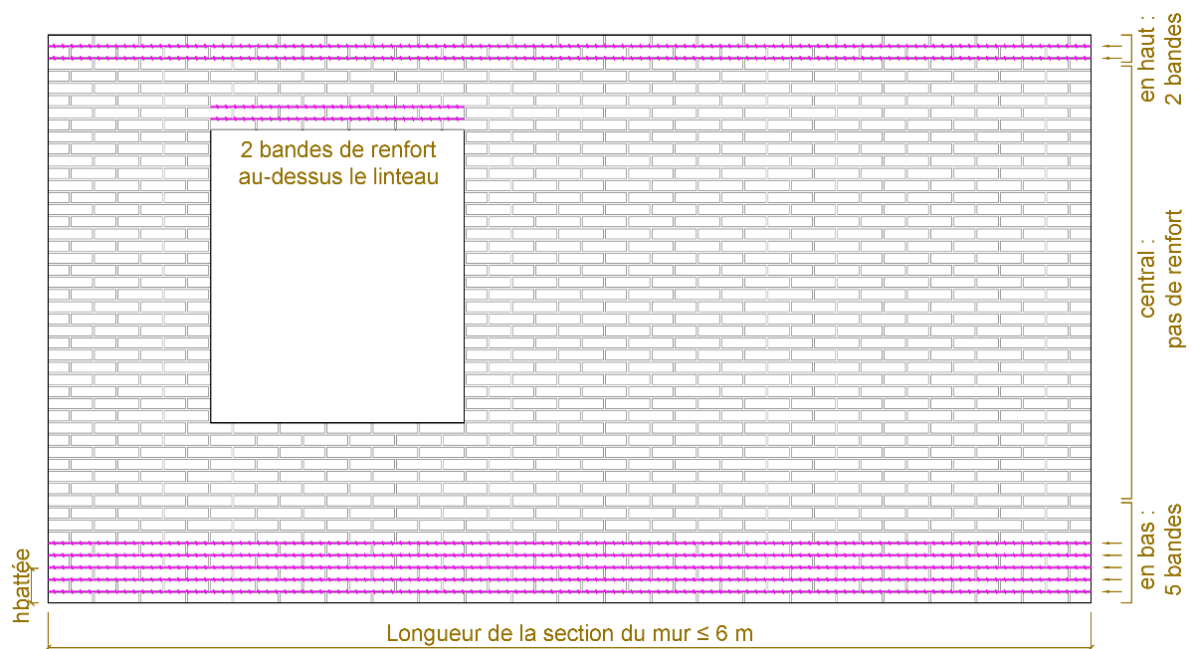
Exemple d'un plan calepinage des renforts de maçonnerie pour des sections du mur ≤ 6 m
